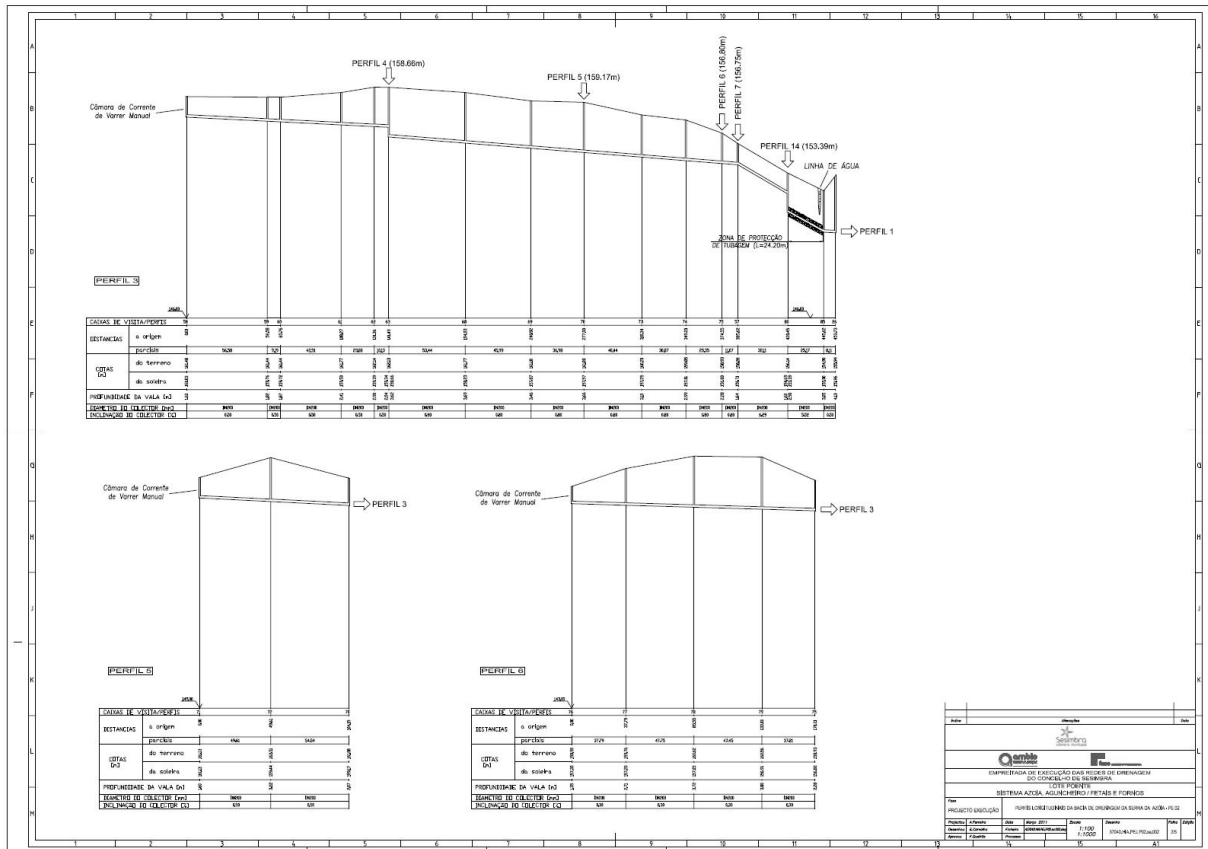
Layout de um desenho de traçado – Planta e Perfis Longitudinais de uma rede de drenagem de águas residuais do Projeto “Redes de Drenagem do Concelho de Sesimbra – Lote Poente” (Fonte: FASE)
